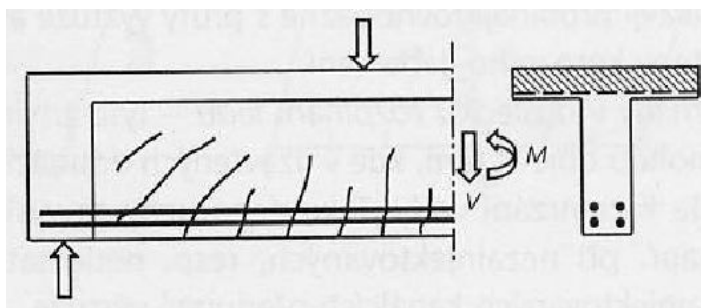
Dělicí trhliny ve štíhlých železobetonových prvcích [2]
